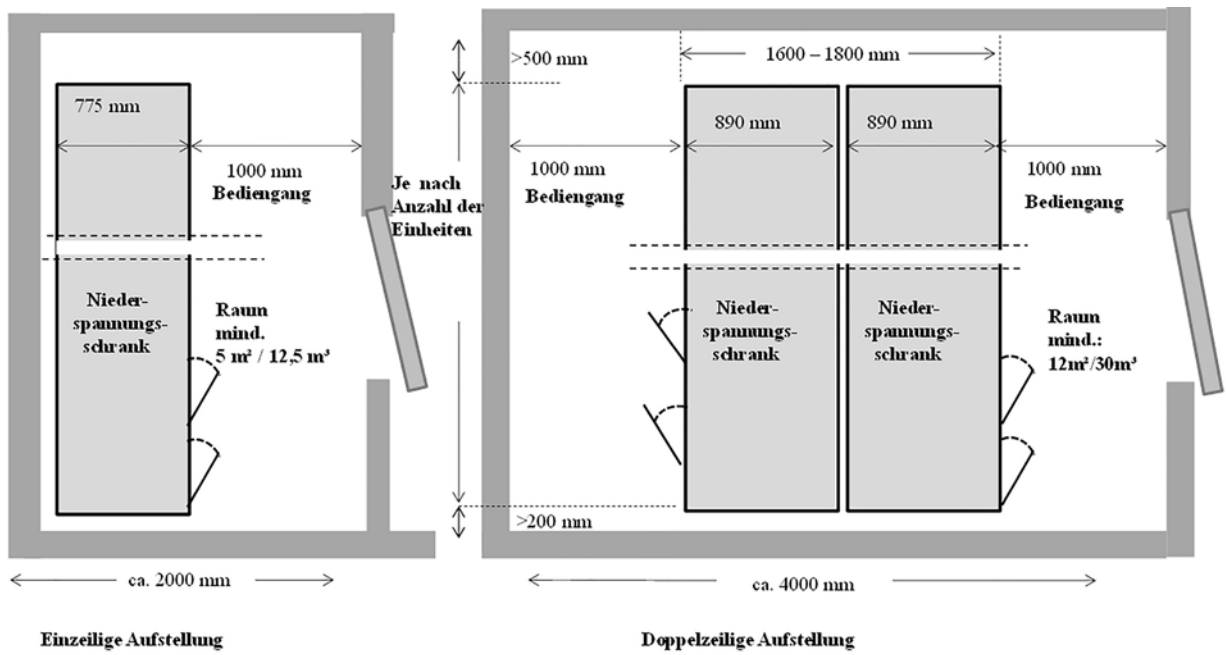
mögliche Schrankanordnung im NVR (Grundriss)
